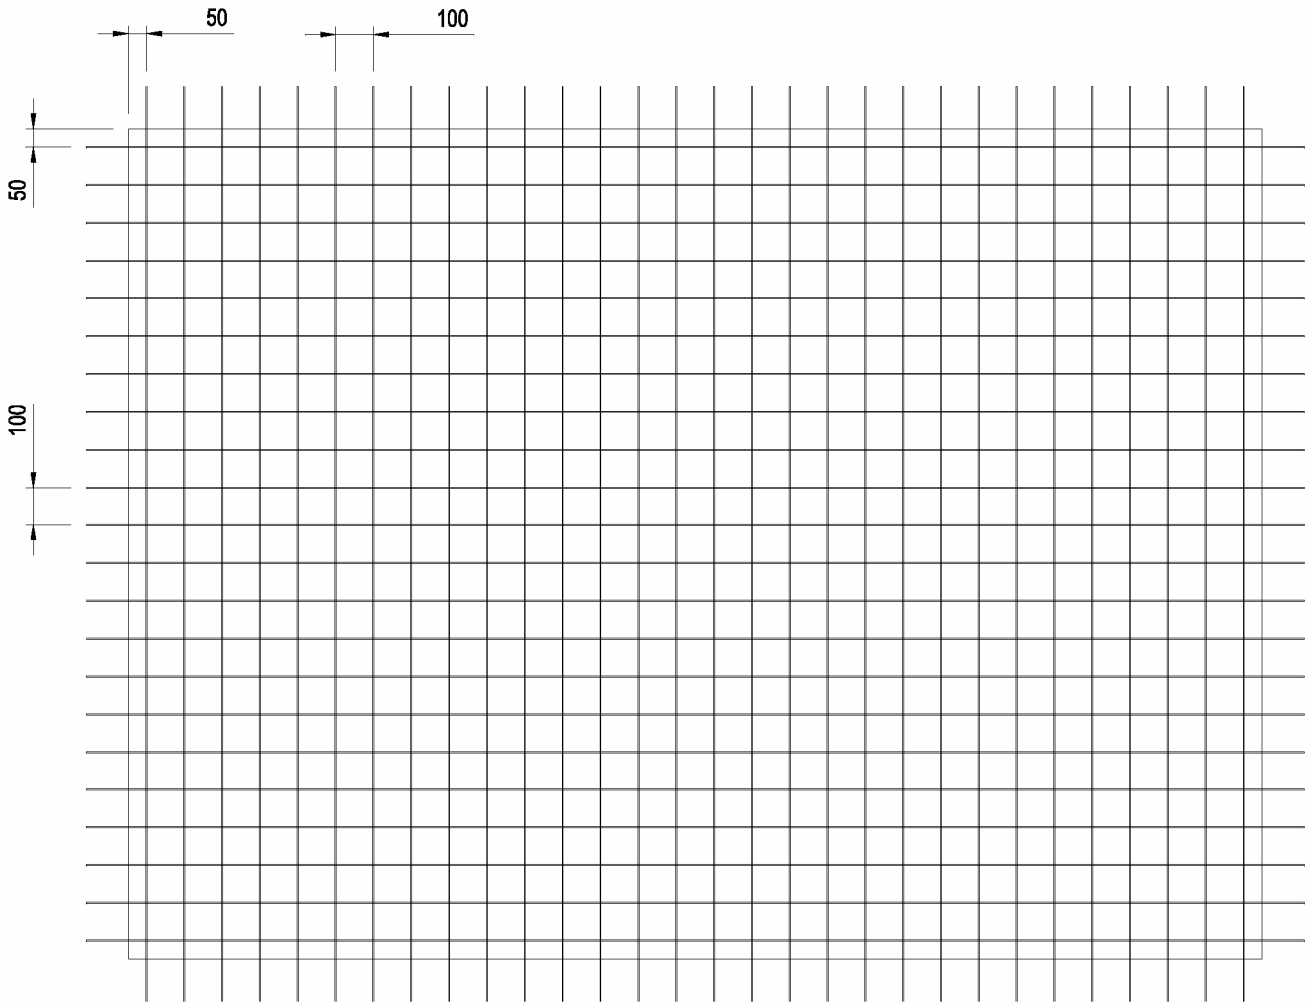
Posicionamiento de los alambres de las armaduras del panel prefabricado.
